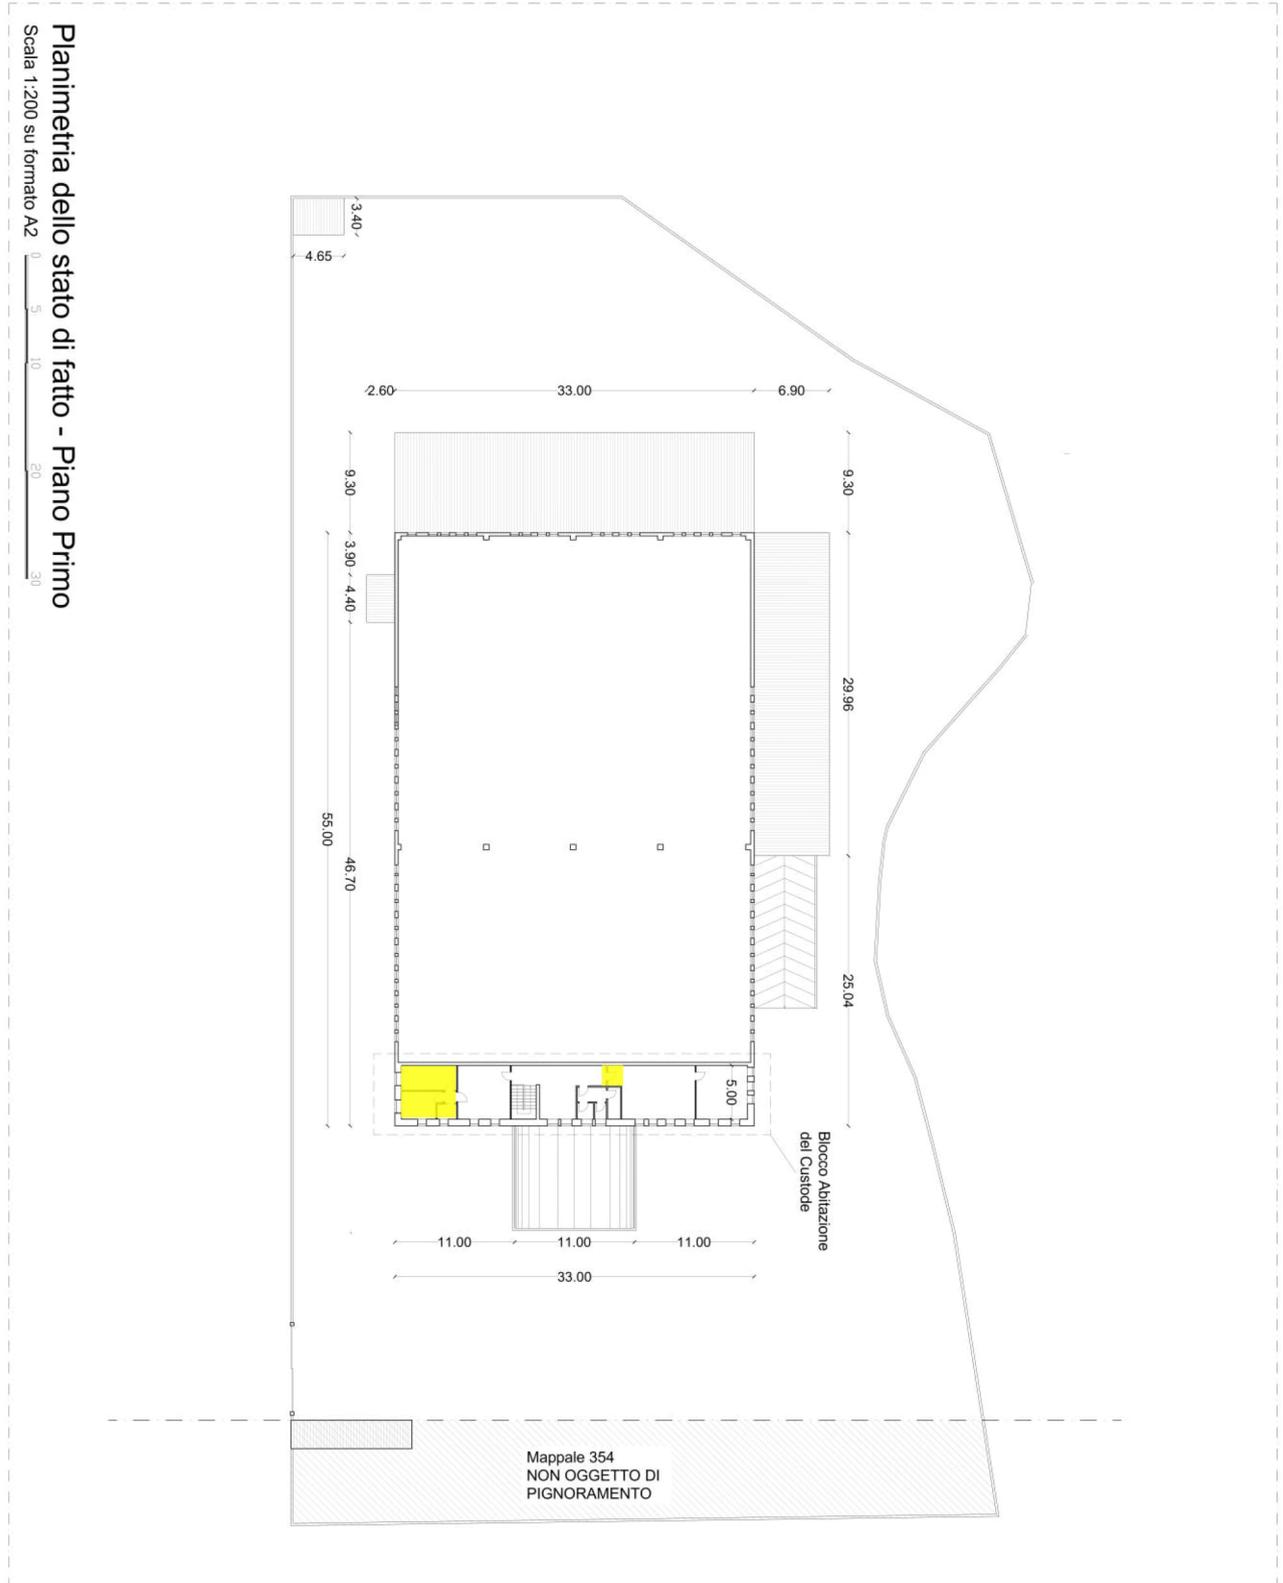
Planimetria stato di fatto con evidenziati gli elementi difformi rispetto a quanto approvato
